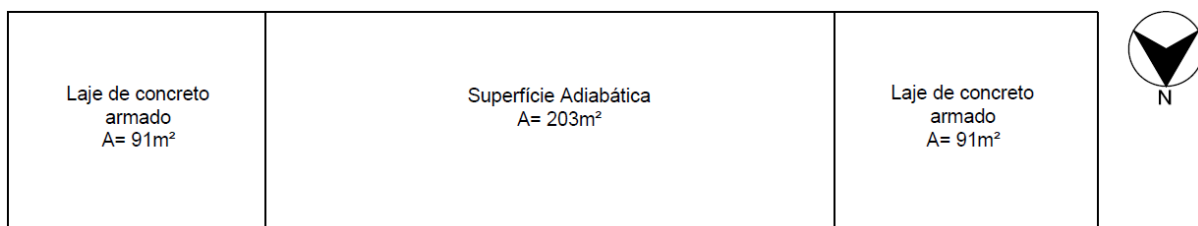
Teto das zonas do décimo quinto pavimento
